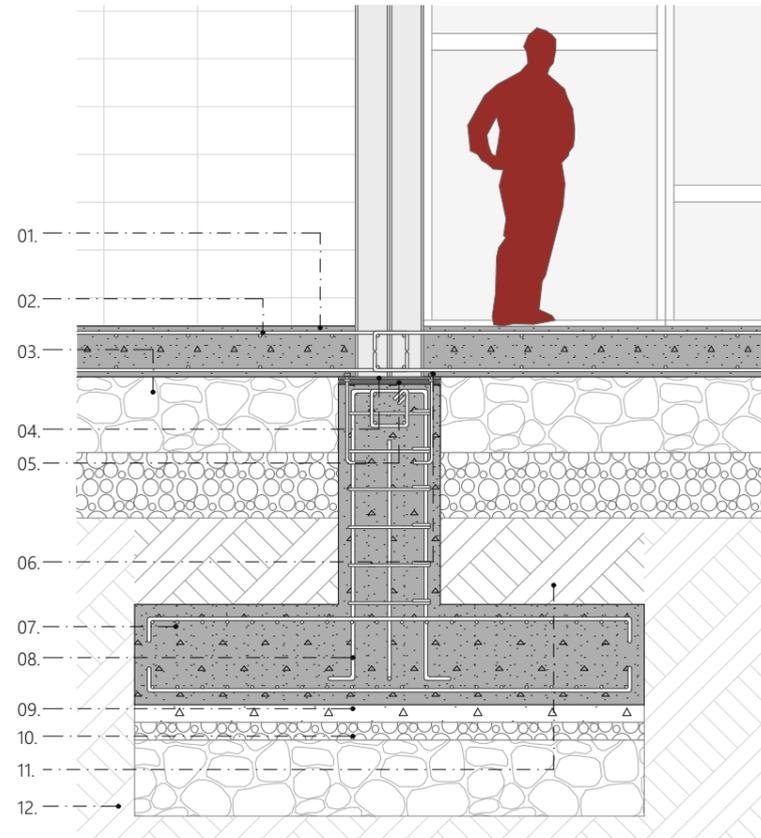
Detalle constructivo Gráfico: Elaboración propia
